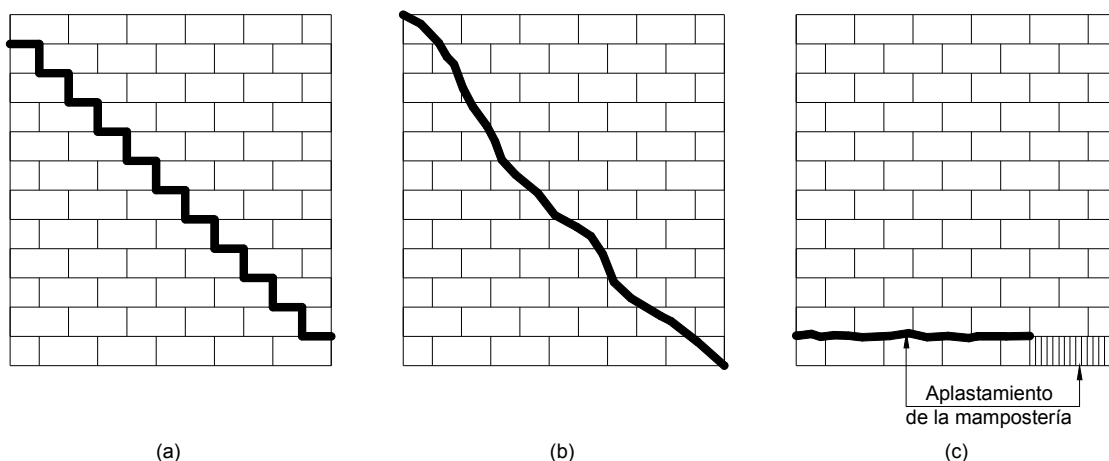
Modos de falla de la mampostería no reforzada sometida a cargas en su plano.
